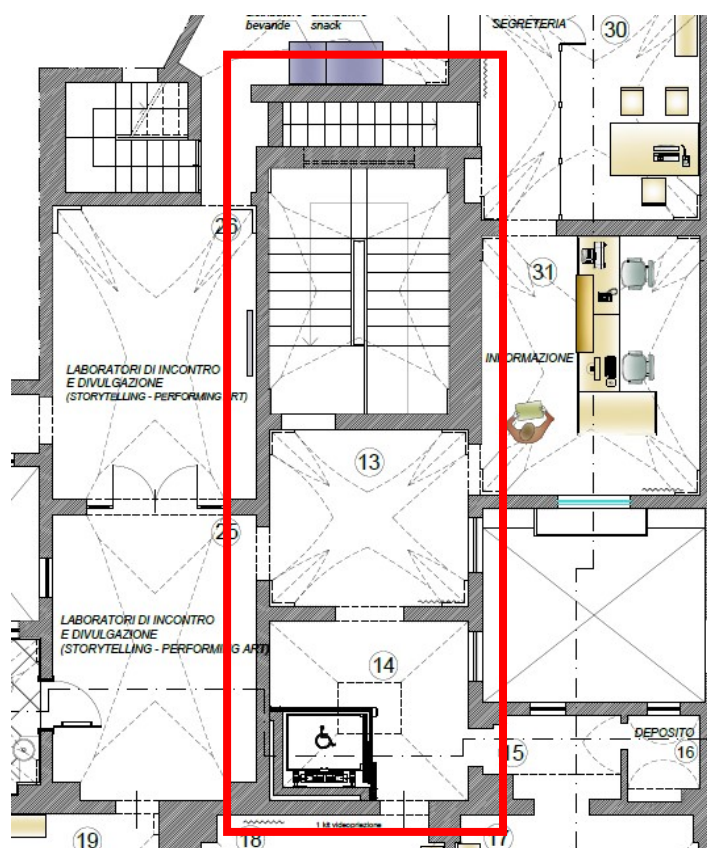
Stralcio della planimetria del piano primo con individuazione degli accessi al piano e (in rosso)
